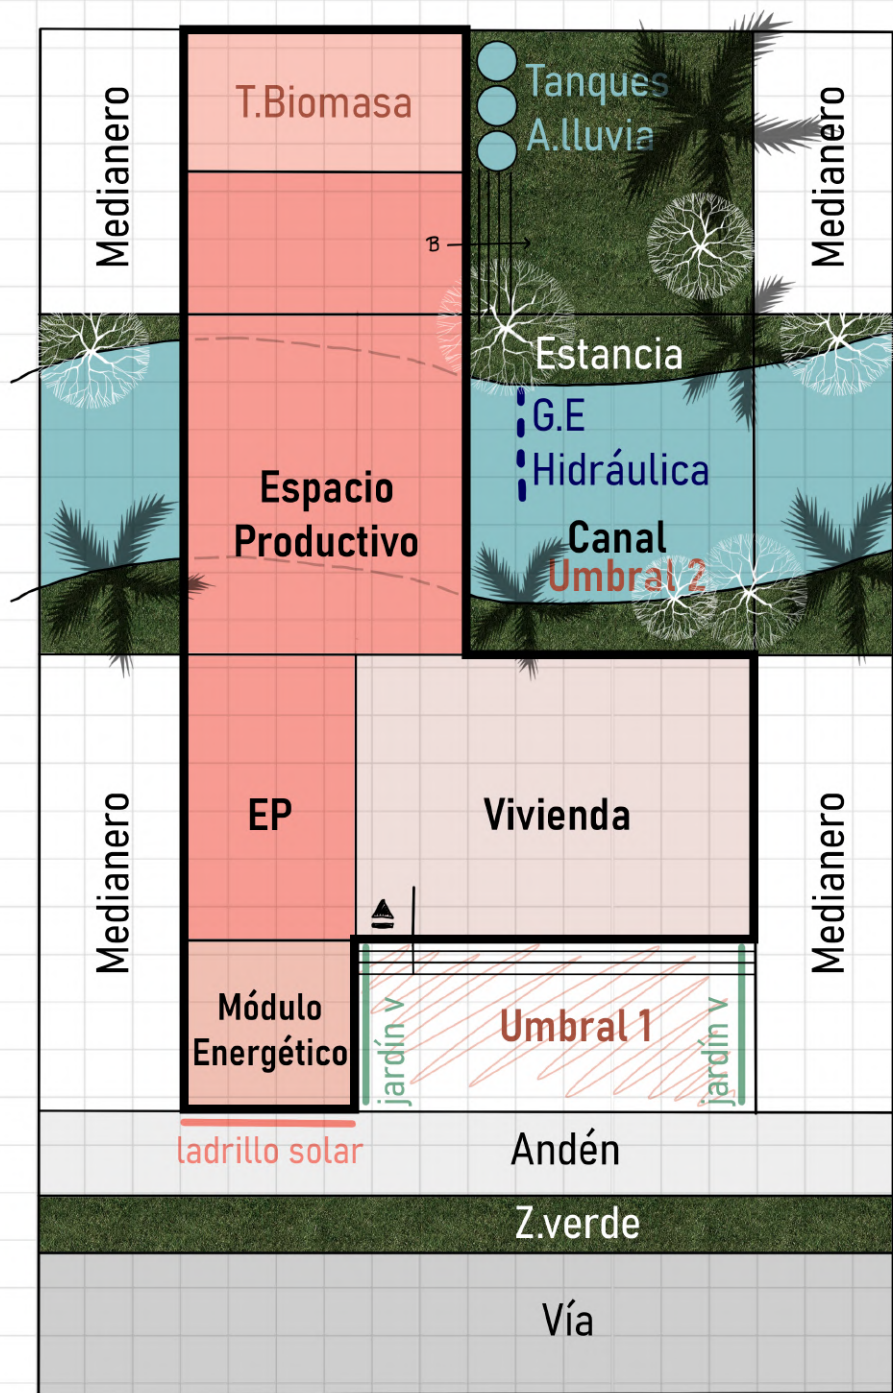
Planta esquemática de la propuesta para la vivienda sobre el canal. Elaboración propia.
